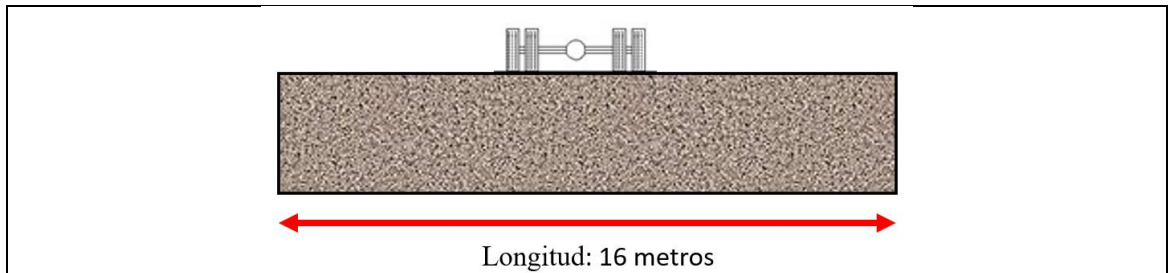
Estructura de pavimento con una longitud de 16 [m]. Fuente: Elaboración propia.
